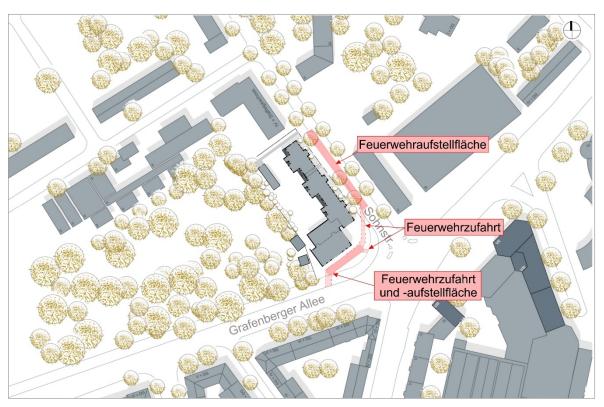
Darstellung des Bauvorhabens als Systemskizze mit den geplanten Feuerwehrzufahrten und den vorgesehenen Feuerwehraufstellflächen in der Sohnstraße und südlich des Kopfgebäudes. Grundlage der Darstellung: Schwarzplan aus dem Gutachterverfahren mit eigenen Anpassungen
